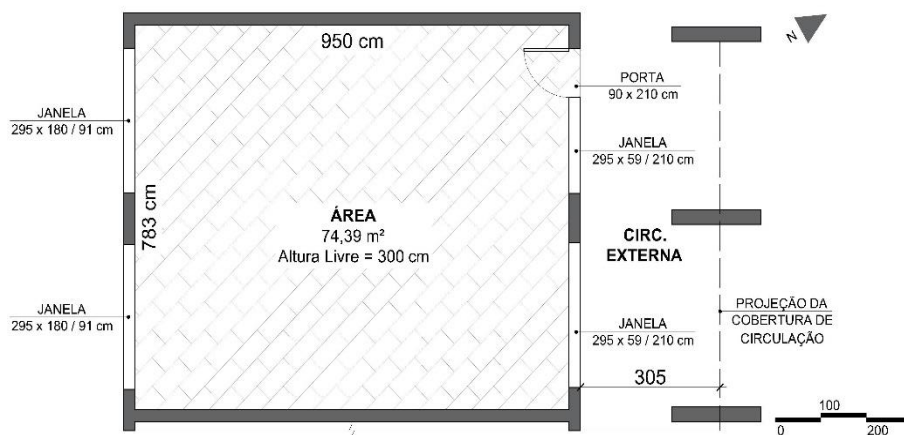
Planta baixa da sala de aula com dados coletados (autores).
